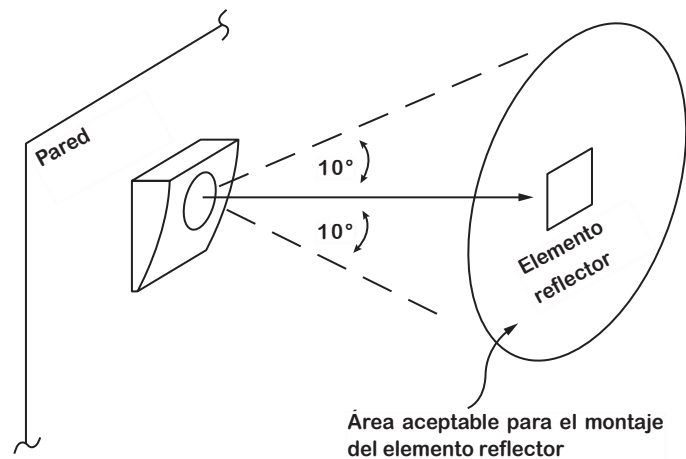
B. LINEAMIENTOS PARA MONTAJE:
